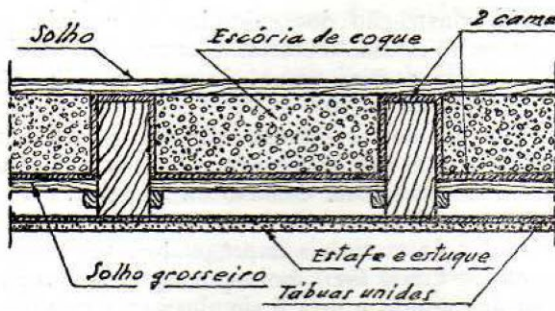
PAVIMENTO E TECTO PROTEGIDOS
